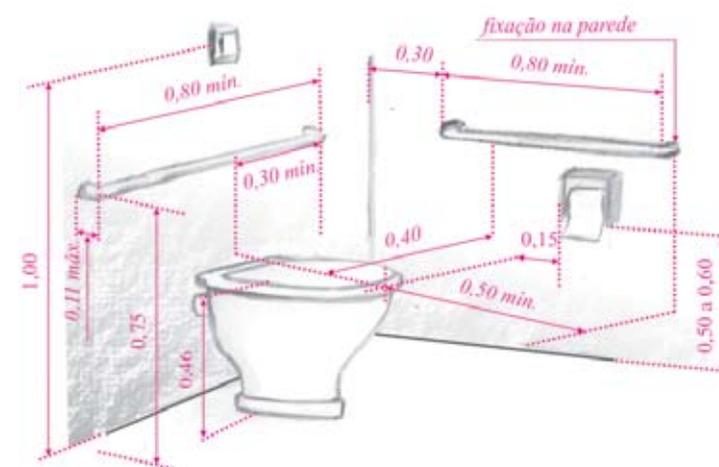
Bacia sanitária - Barras de apoio lateral e de fundo
